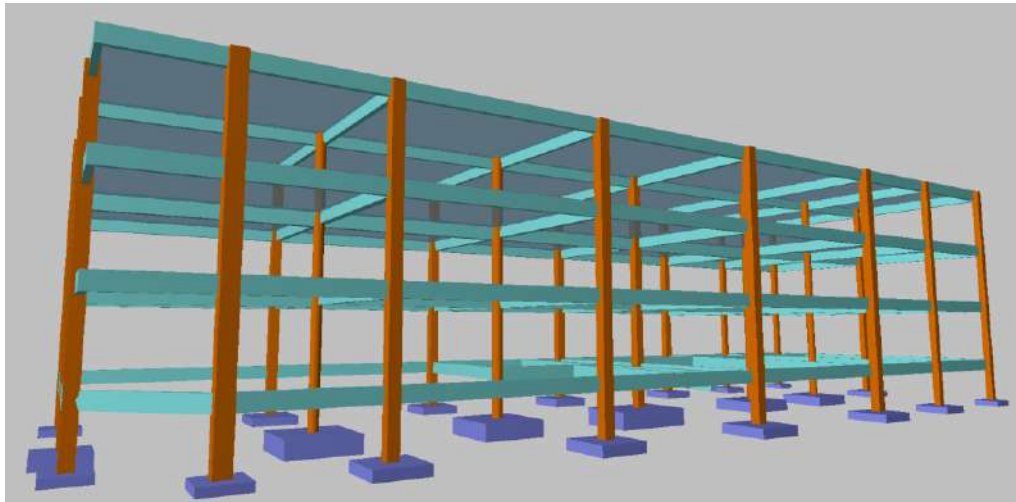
19 - 3D del diseño de losas macizas con vigas
